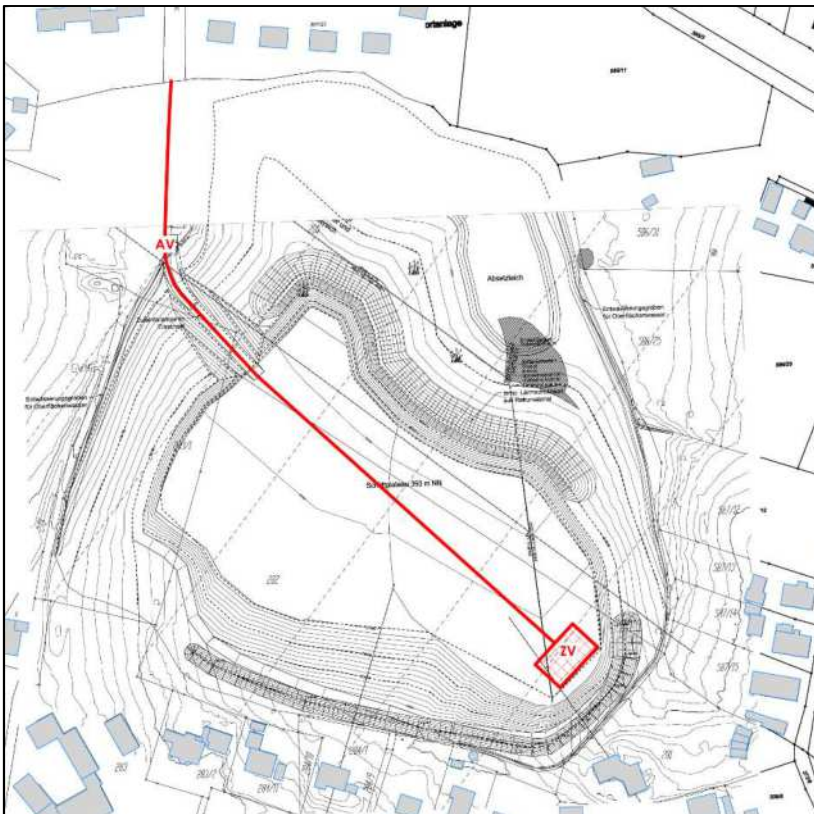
Lageplan mit Darstellung der relevanten Schallquellen – Variante 2
